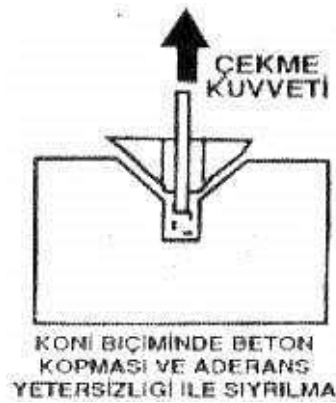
Düşük dayanımlı betonda koni biçiminde beton kopması
